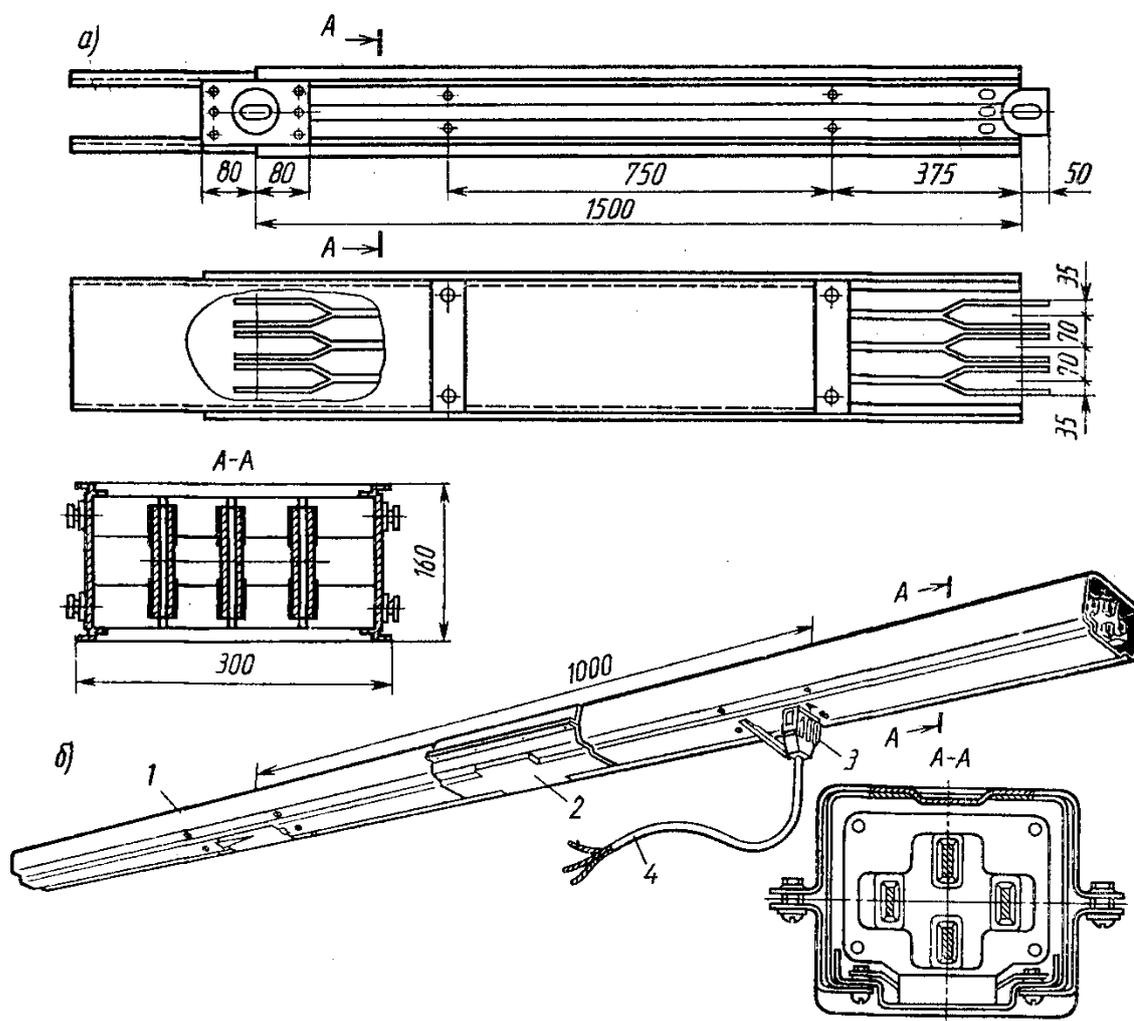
Магистральный шинопровод ШМА-73: *а* - распределительный ШРА-73; *б* - осветительный ШОС-73; 1 - прямая секция; 2 - соединительная муфта; 3 - ответвительный штепсель; 4 - провод к светильнику
